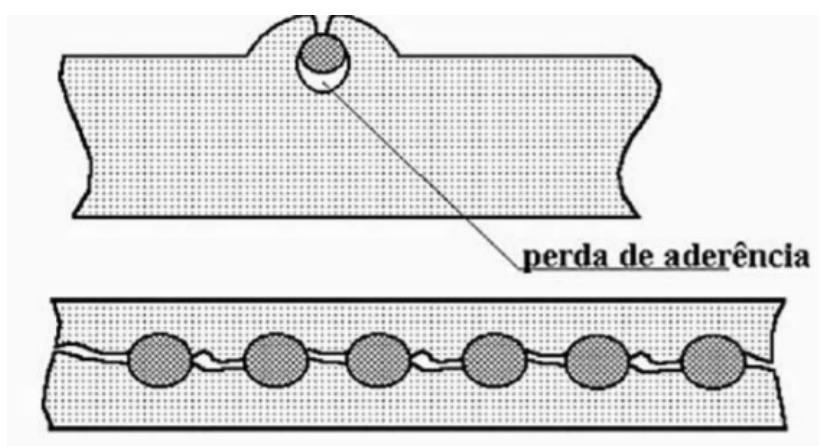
Fissuração por assentamento plástico - efeito de parede (Souza, 1998)
